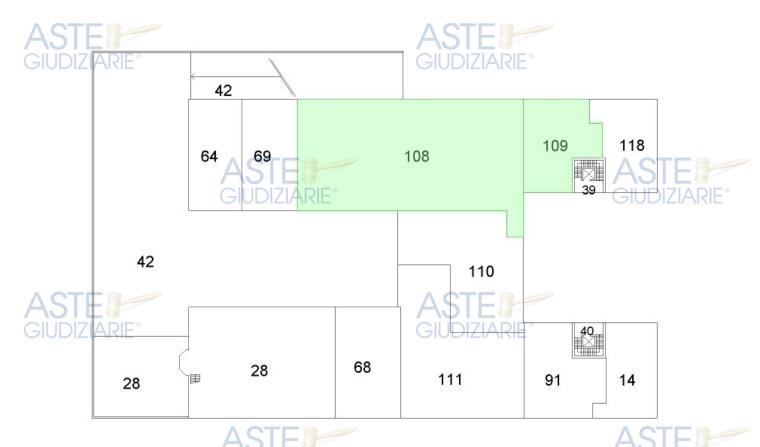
Individuazione unità immobiliari in oggetto su estratto elaborato planimetrico catastale –piano primo
